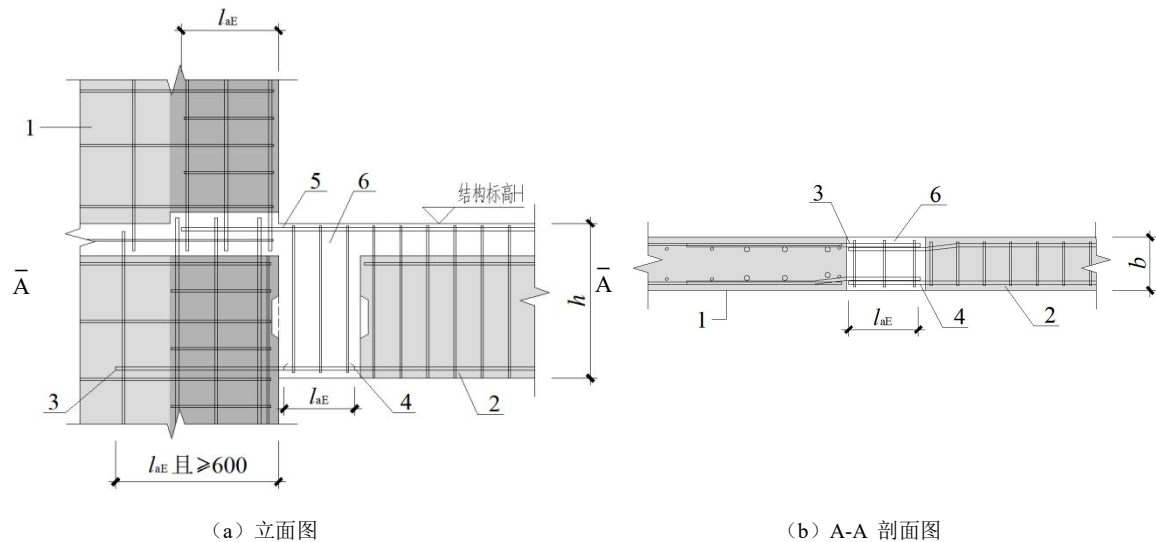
预制墙与叠合梁在平面内连接节点示意
